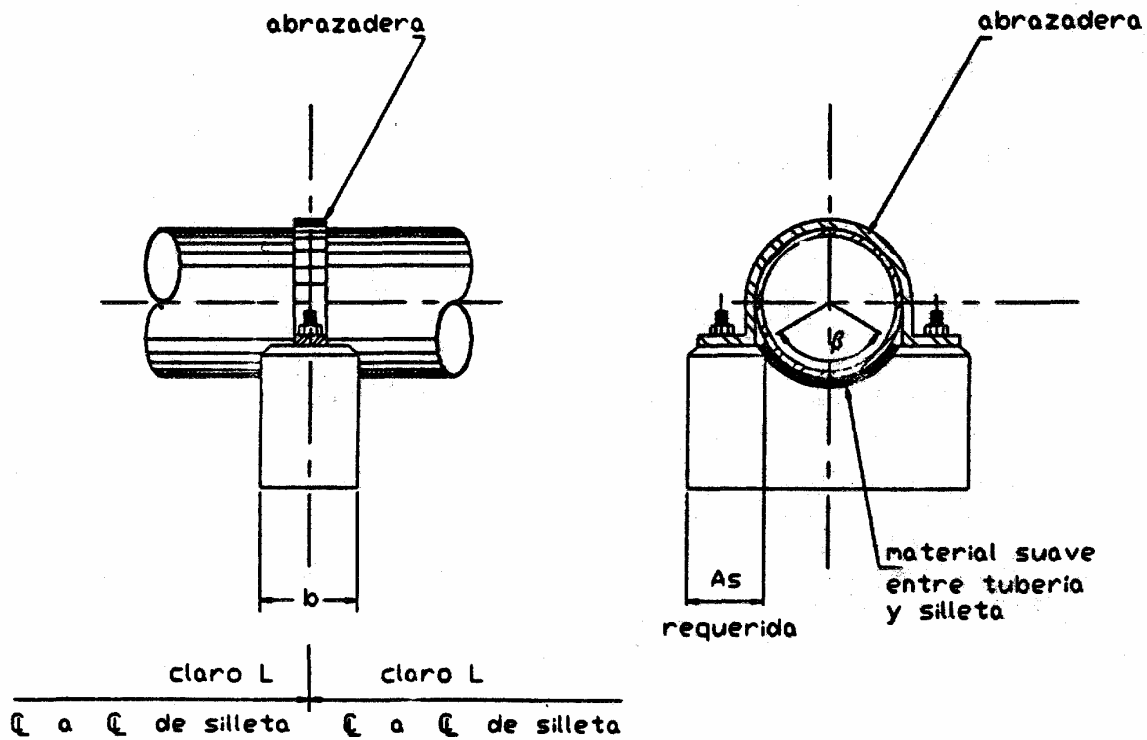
Detalle de apoyo sobre silleta de concreto
